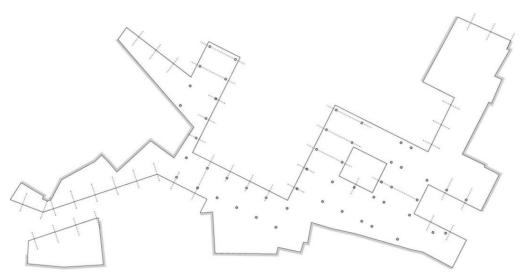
Esquema en planta de la relación entre estructura y módulos en fachada.
